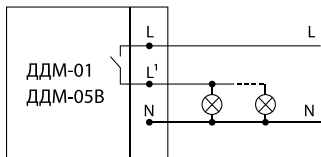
Схема подключения датчиков движения ДДМ-01, ДДМ-05В
